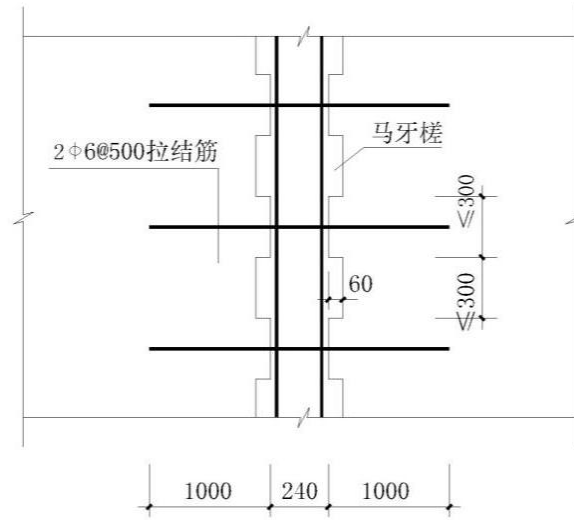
拉结钢筋布置及马牙槎示意图 (单位: mm)
